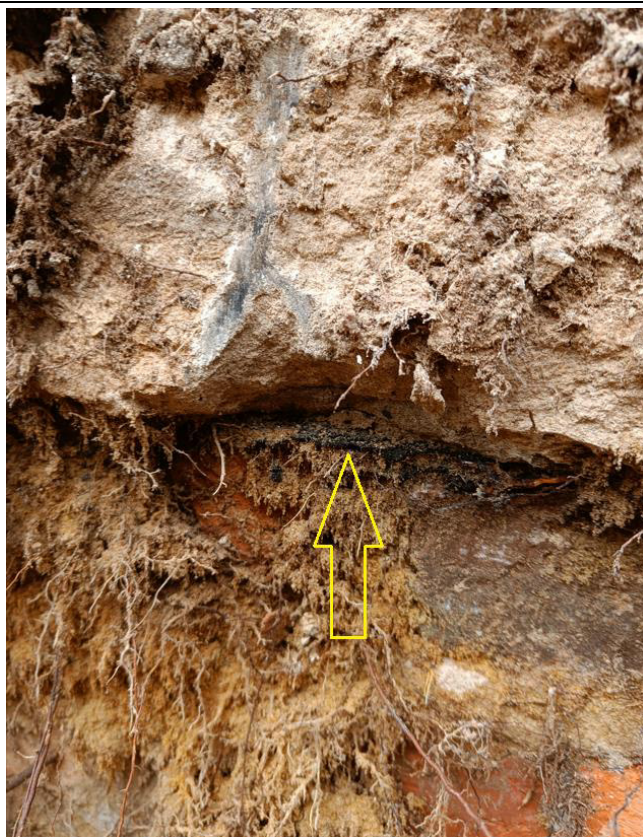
Odkrywka F.2. fundamentów. W wykonanej odkrywce stwierdzono ścianę fundamentową ceglana posadowioną na gruzobetonowej ławie gr. 44cm z odsadzką 6cm. Ława jest posadowiona około 134cm p.p.t.
